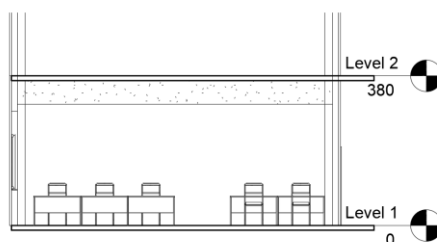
Plafon Ruang Kelas Studio Gambar 3
